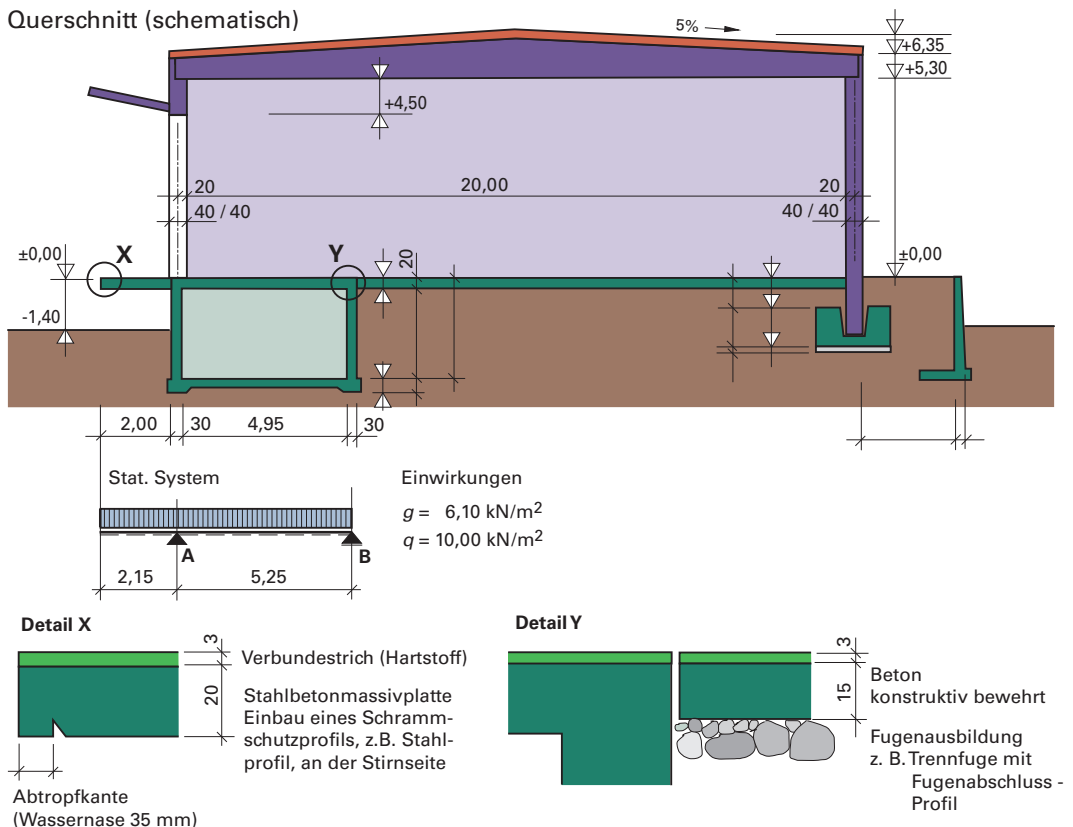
Querschnitt einer Lagerhalle mit Teilunterkellerung
